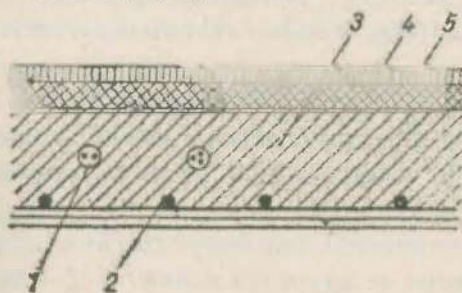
Montarea tuburilor îngropate în placa de beton armat :
